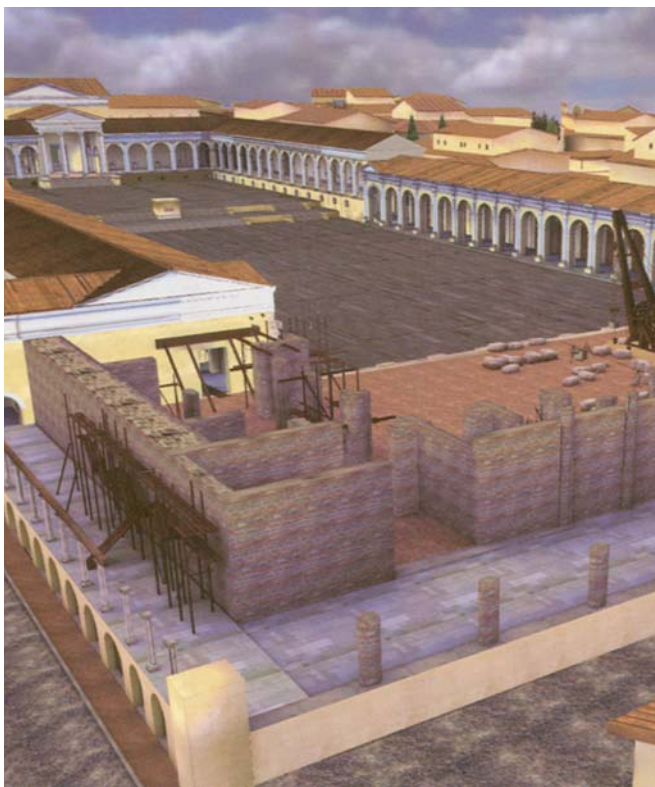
Vue d'ensemble du forum reconstitué.
